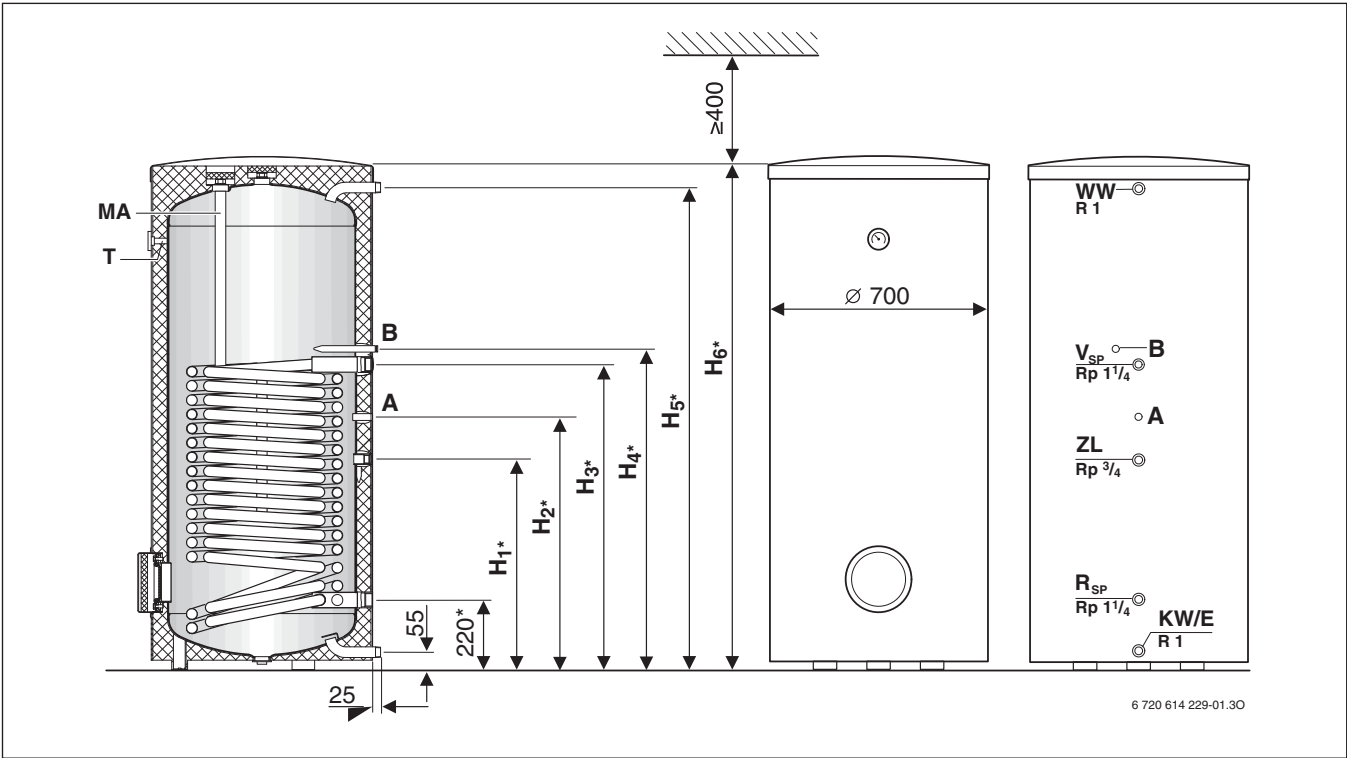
Bau- und Anschlussmaße der Warmwasserspeicher SW 400-1...SW 450-1 (Maße in mm)
